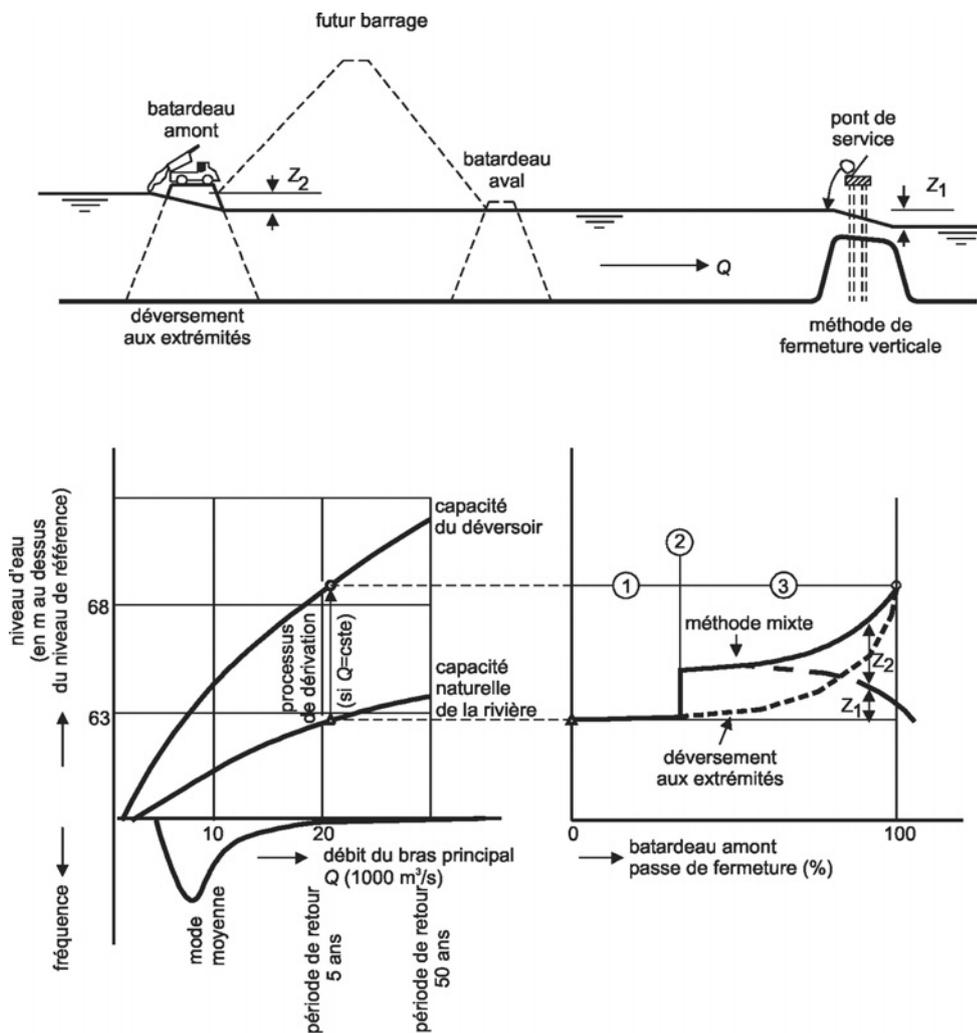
Système de dérivation de Yacreta, rivière Parana (Argentine)
